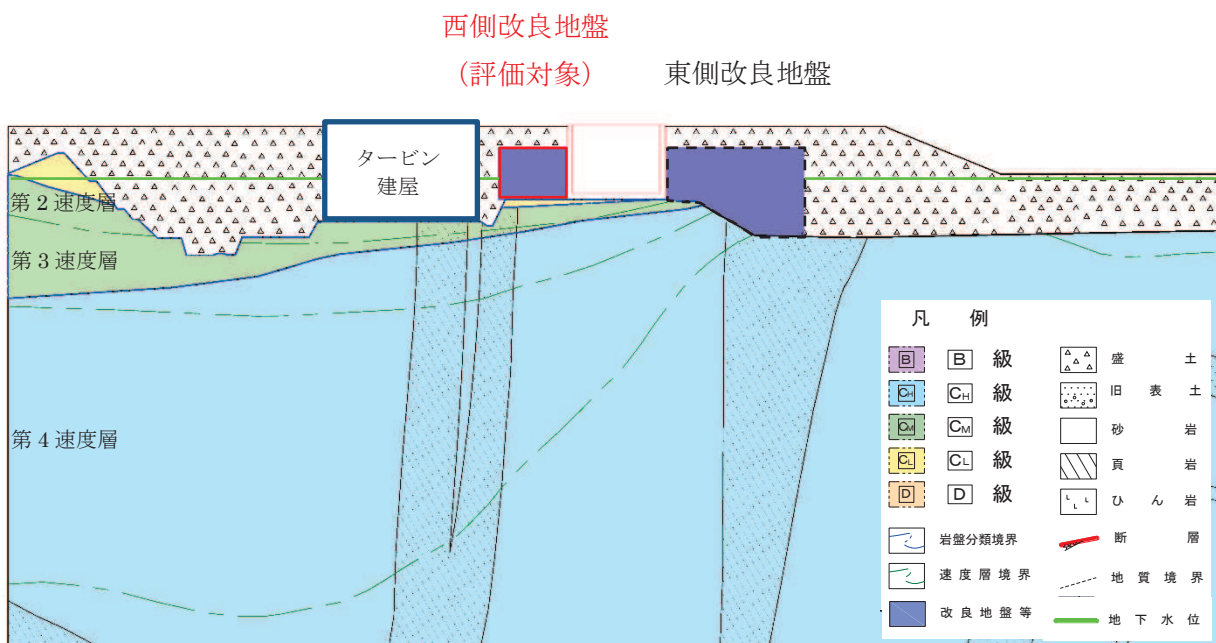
2号放水立坑改良地盤の評価対象断面 地質断面図 (A-A 断面)
